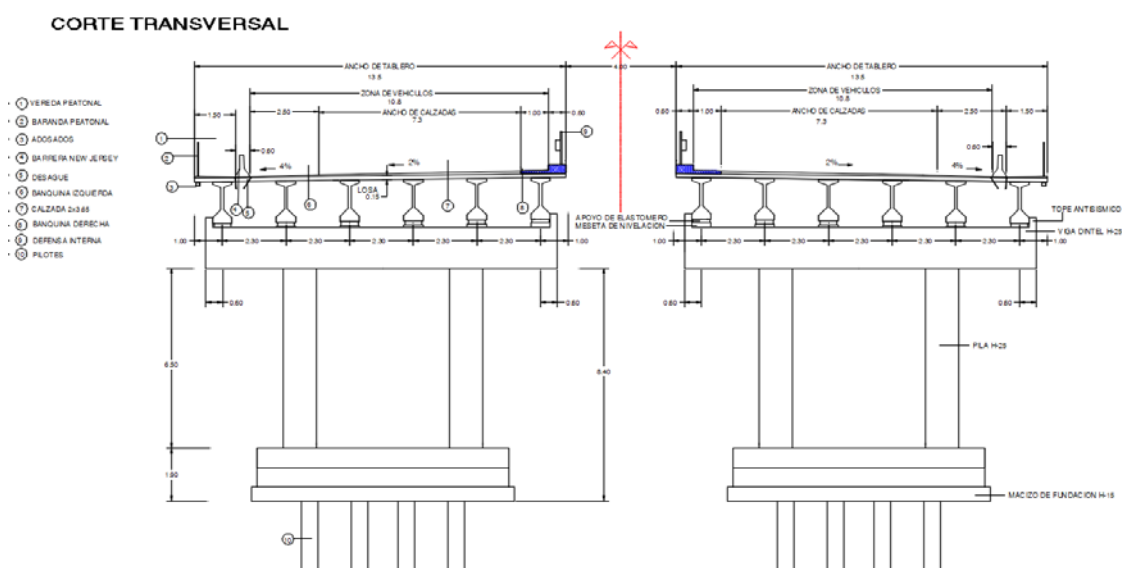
Ilustración XXXI. Corte Transversal Puente (Para ver el plano en detalle, consultar la carpeta de planos del proyecto.)
